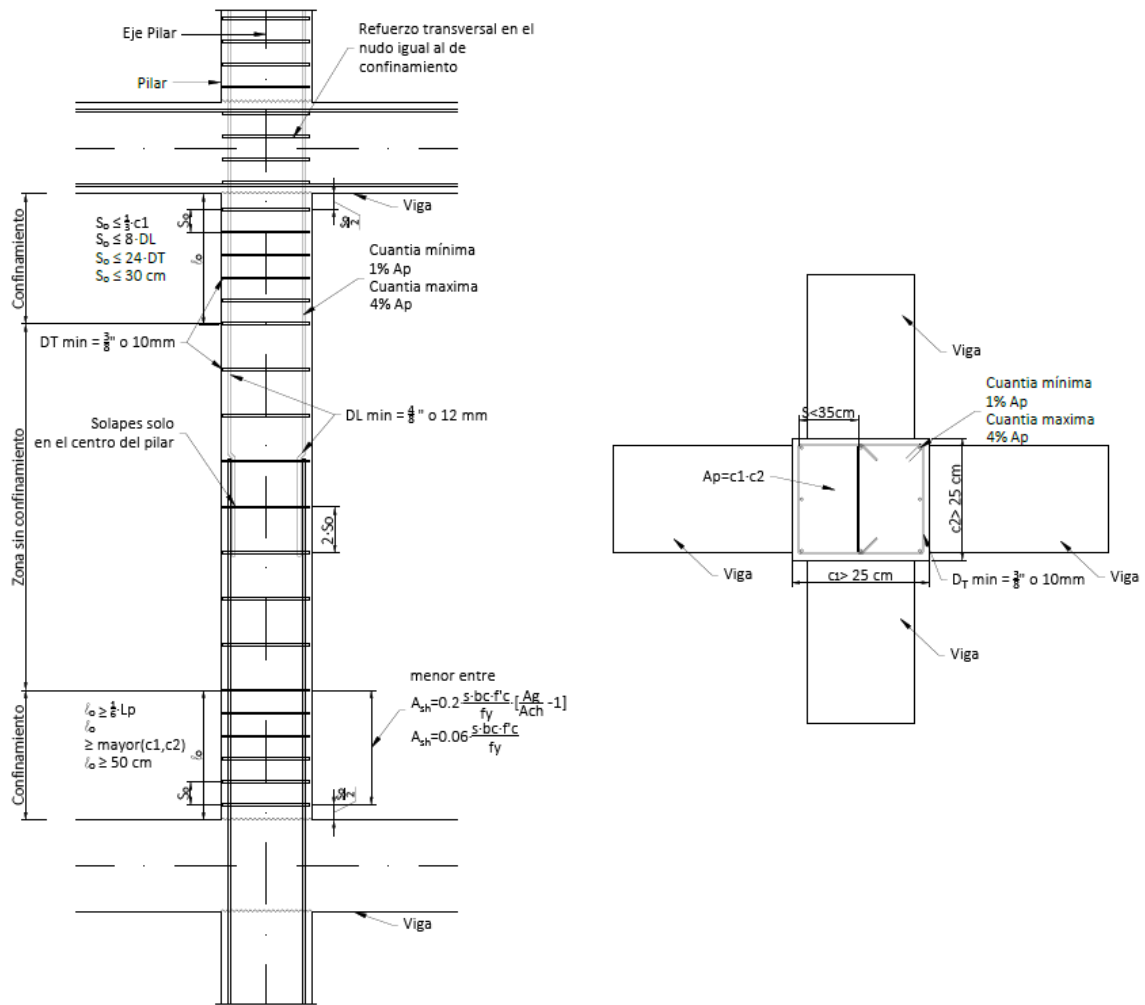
Detalle general estructural del PILAR para ductilidad DMO
